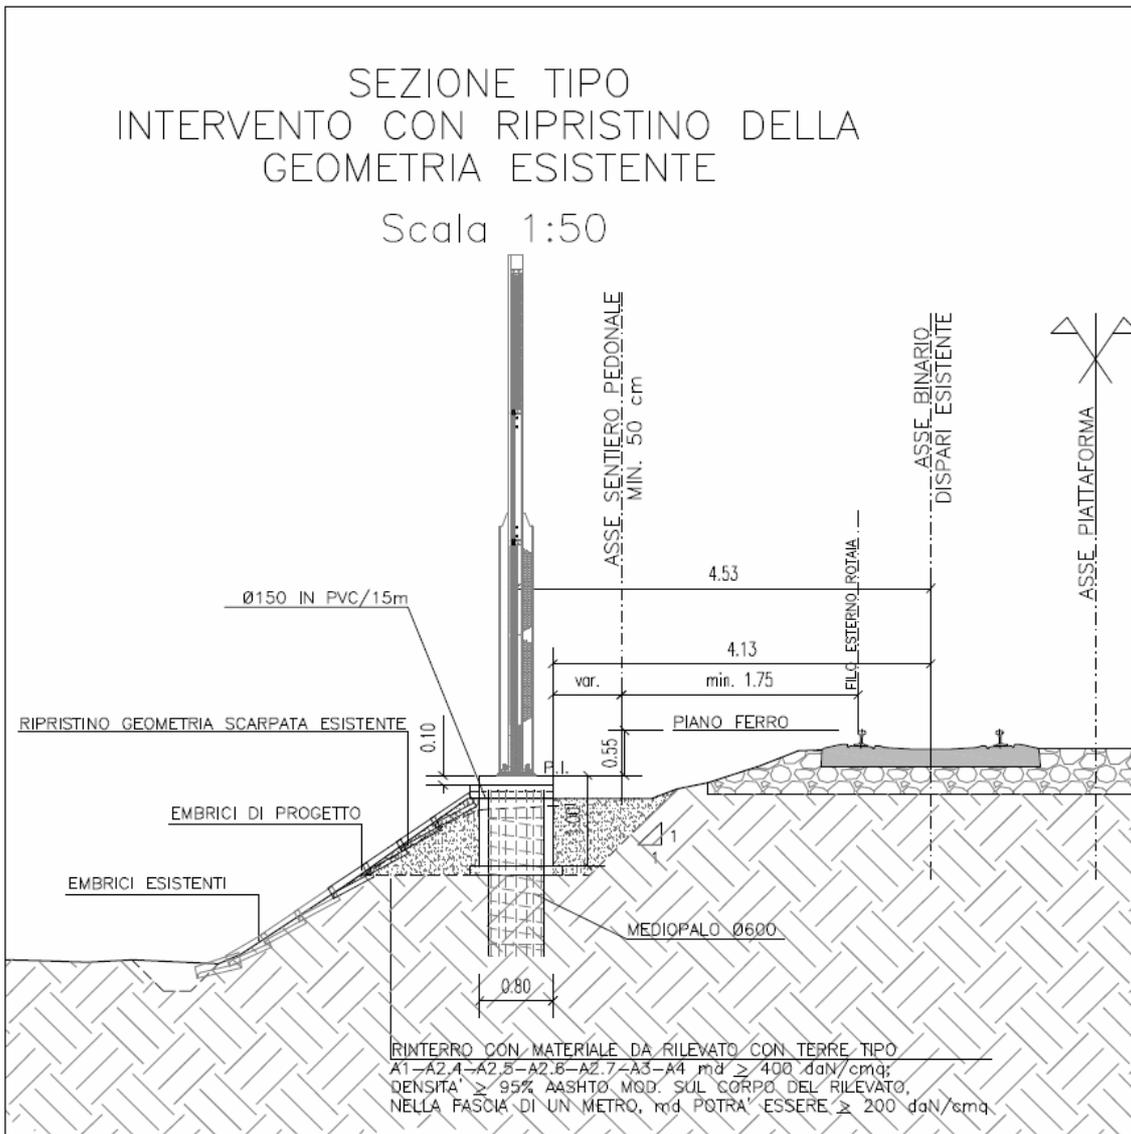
sezione tipologica di linea in rilevato (BA01÷BA15 e BA18÷BA20)
